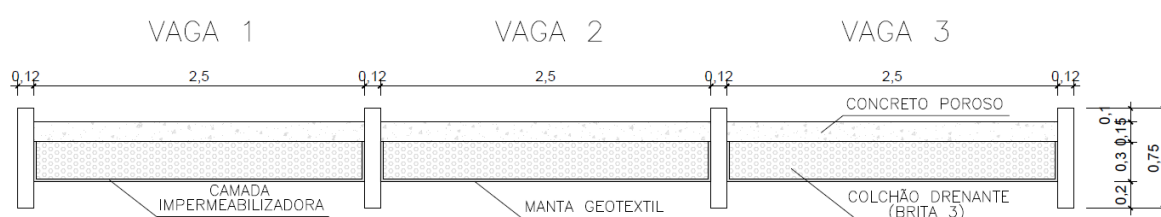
Corte AA - Perfil transversal do pavimento
